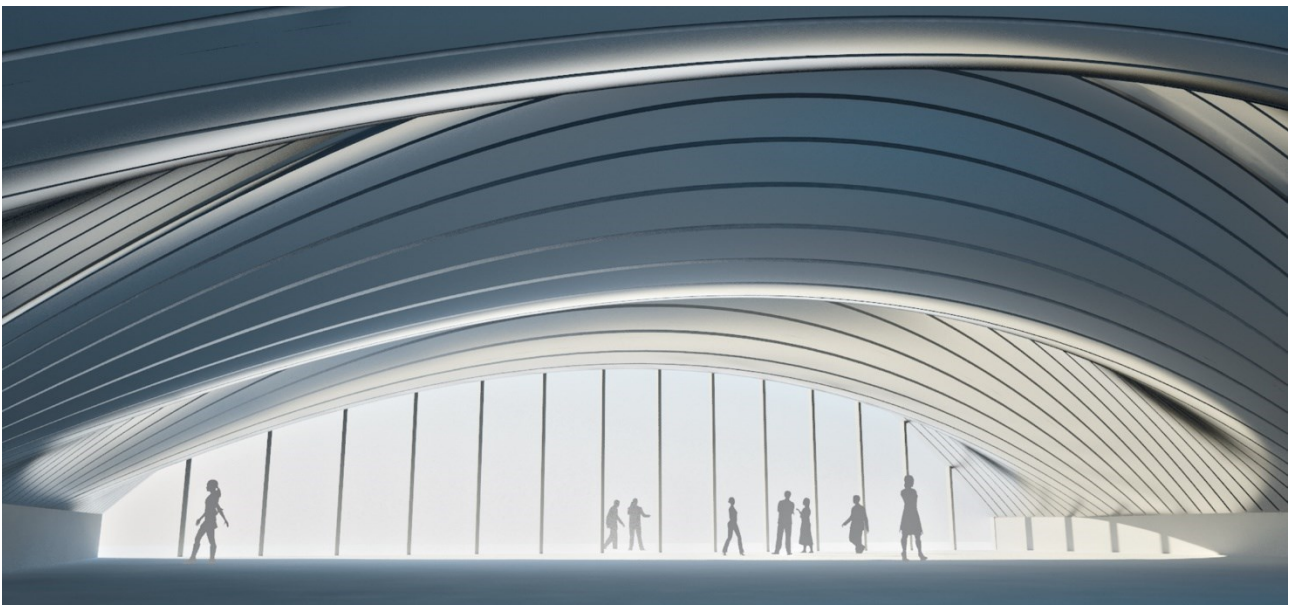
Hallendach, welches mit Elementen der Komplexitätsstufe 3 möglich wäre [8]
